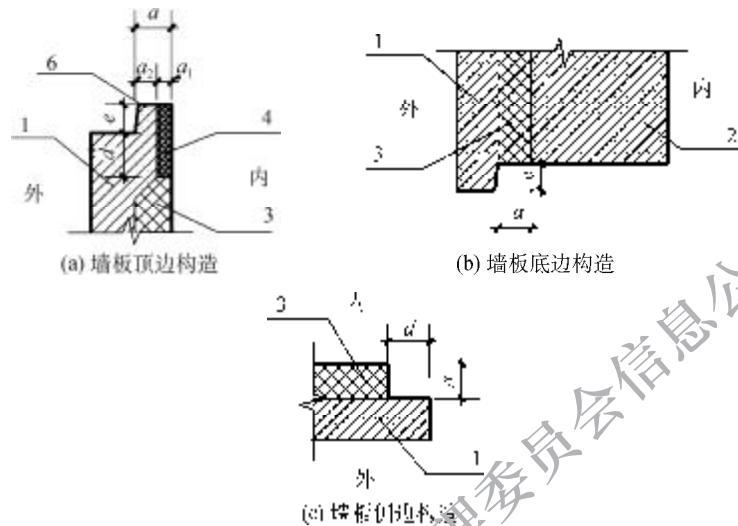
预制实心混凝土夹心保温剪力墙板板边构造
